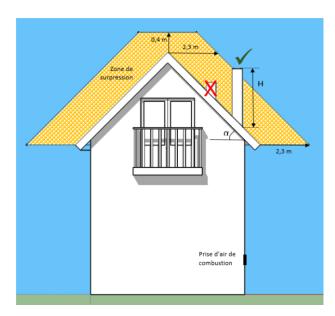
Air frais de la façade - tuyau 130/200 mm
